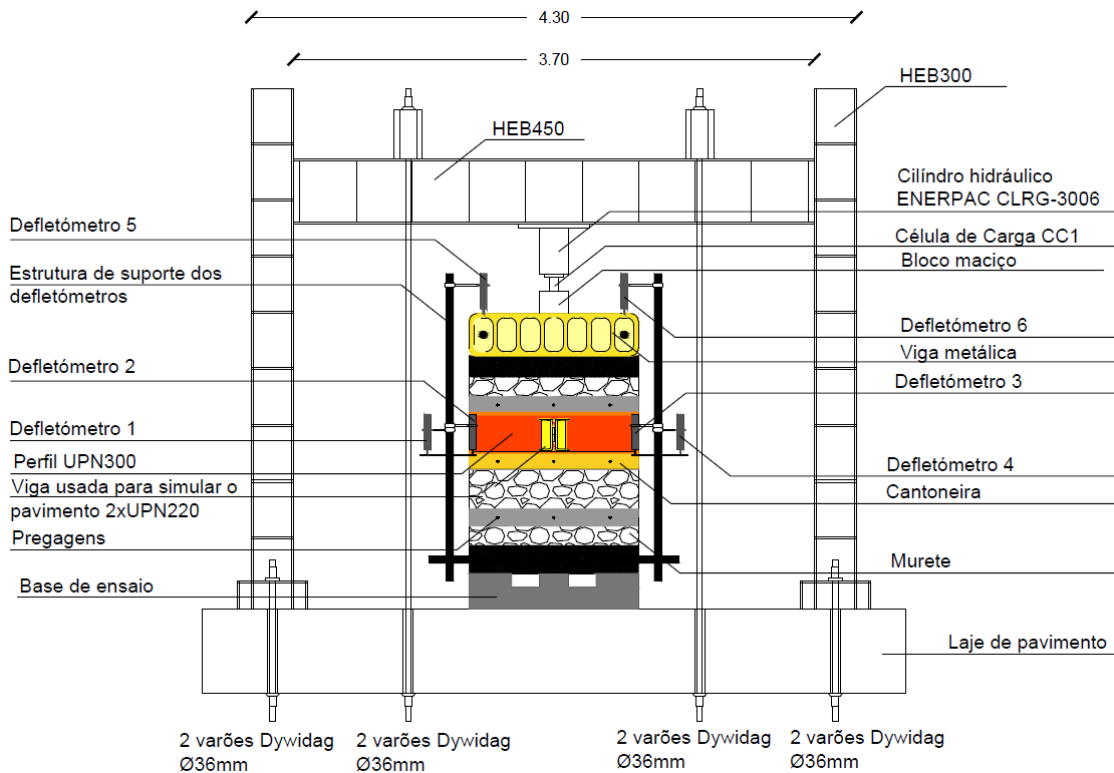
Vista frontal do ensaio compressão axial (adaptado a ensaio de ligação parede-pavimento)
